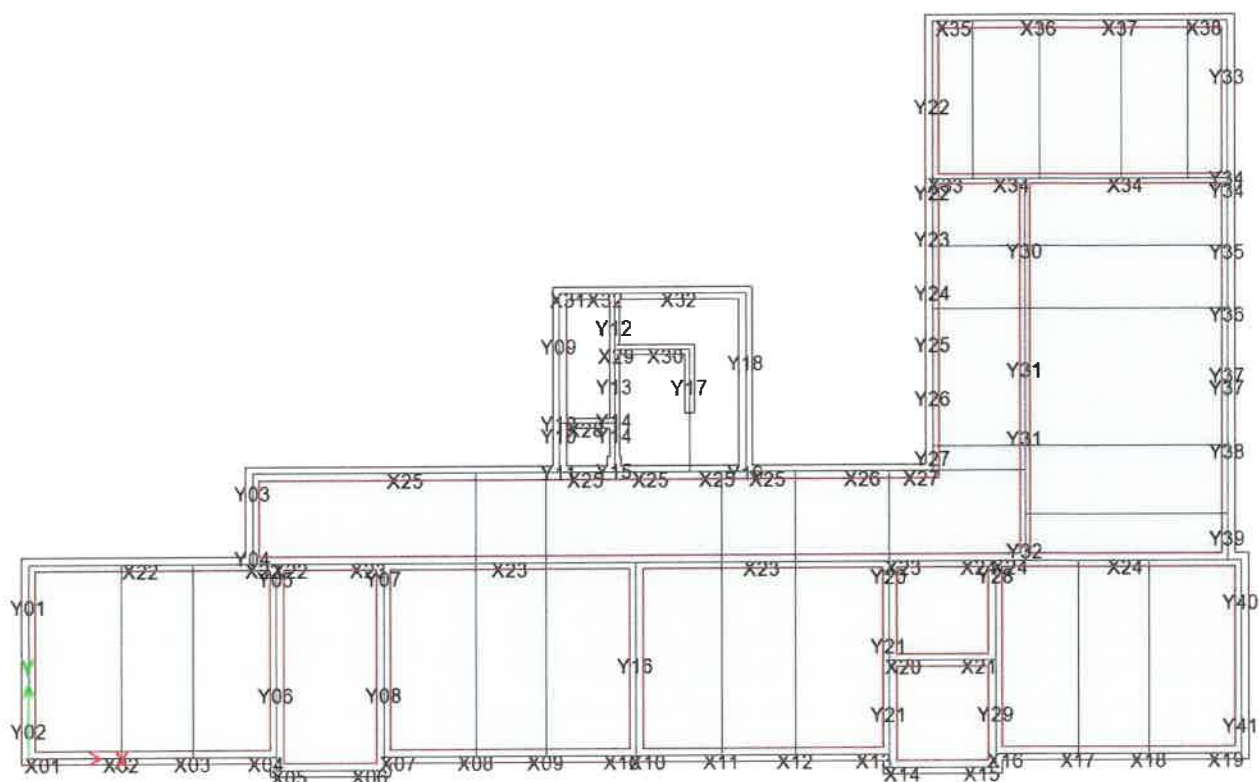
Vedere in plan spaleti din zidarie (parter)
